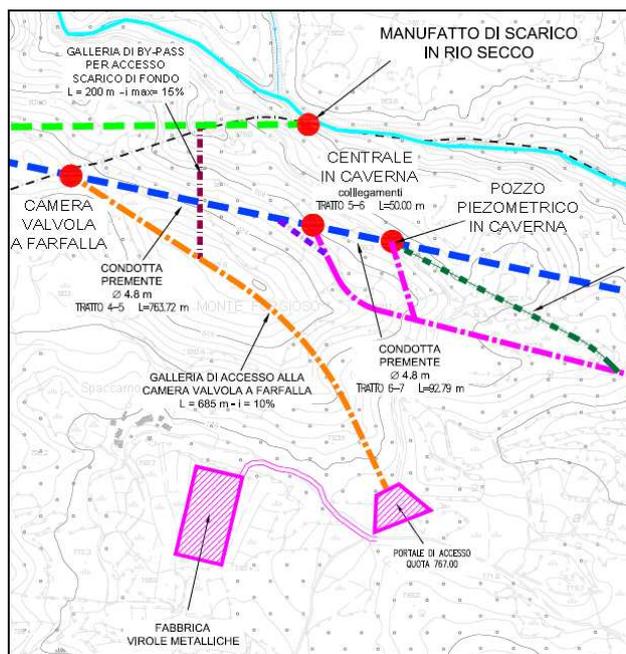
stralcio planimetrico galleria di accesso alla camera paratoie di monte
